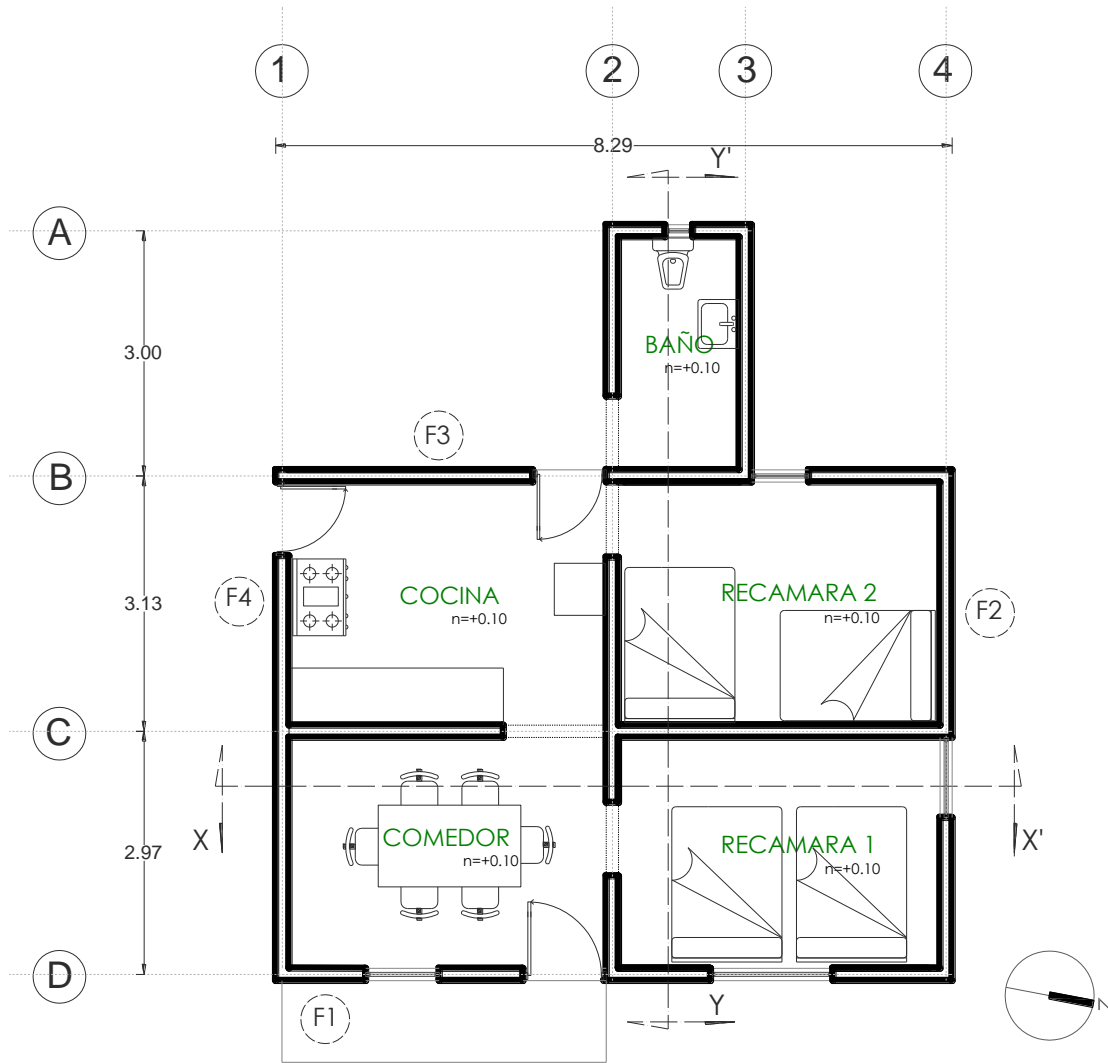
Planta Arquitectónica - Vivienda Tipo. Fuente: Elaboración propia.
